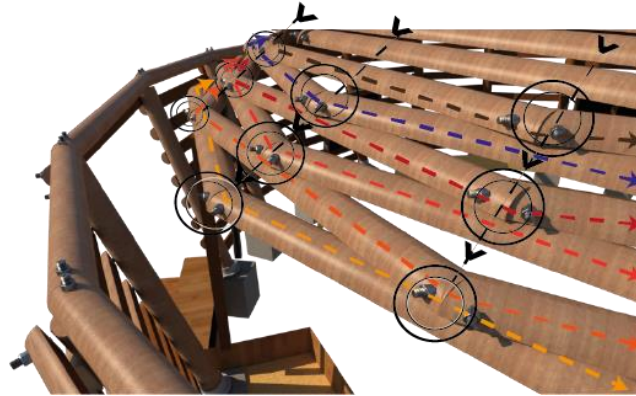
Posición cubierta verde sobre estructura Hogan
